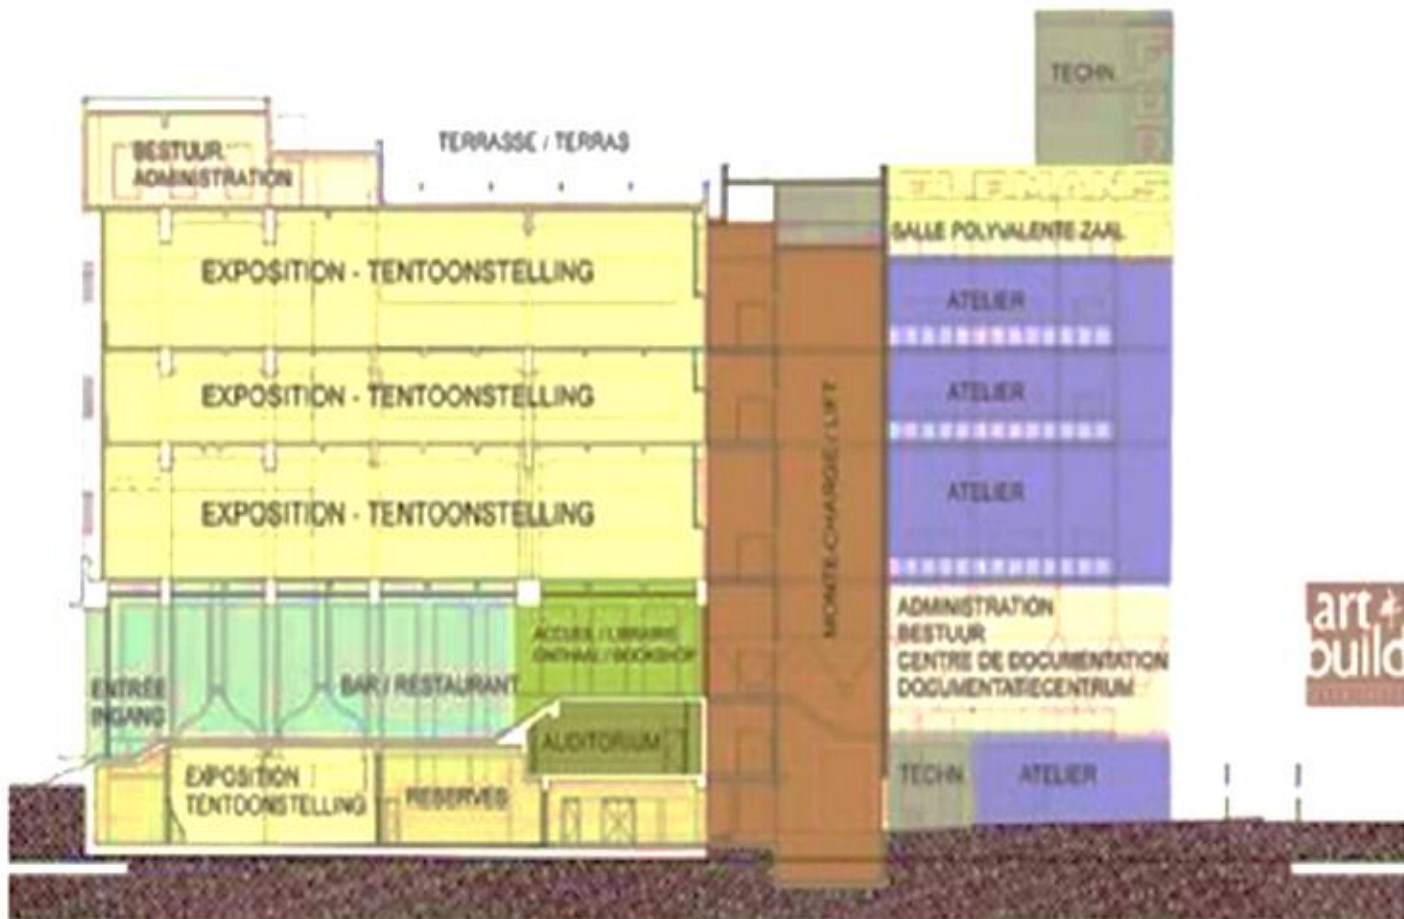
COUPE SCHEMATIQUE FONCTIONNEL DU BATIMENT SOURCE: SITE WEB ART BUILD.
